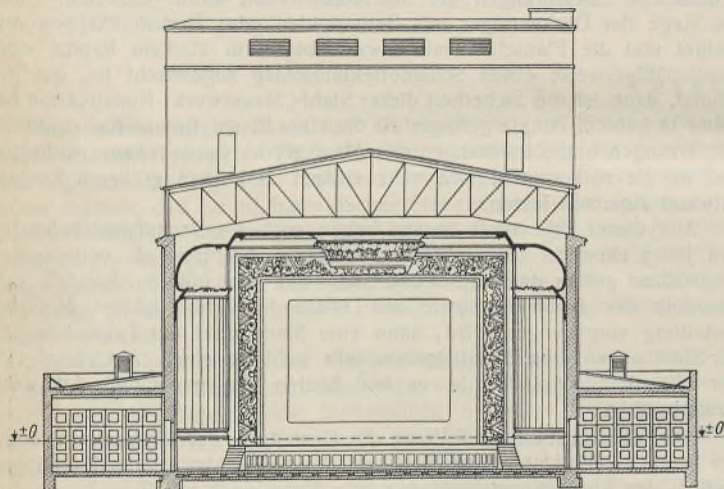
Querschnitt gegen die Bühne mit Dachbinder und Saaldecke.
